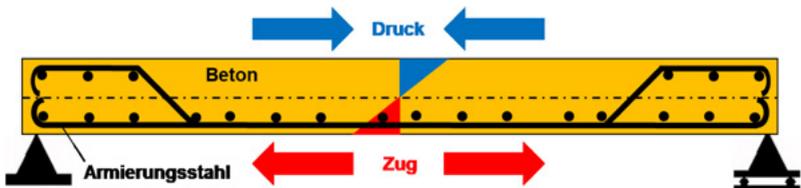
Querschnitt durch eine Stahlbetondecke (stark vereinfacht)
